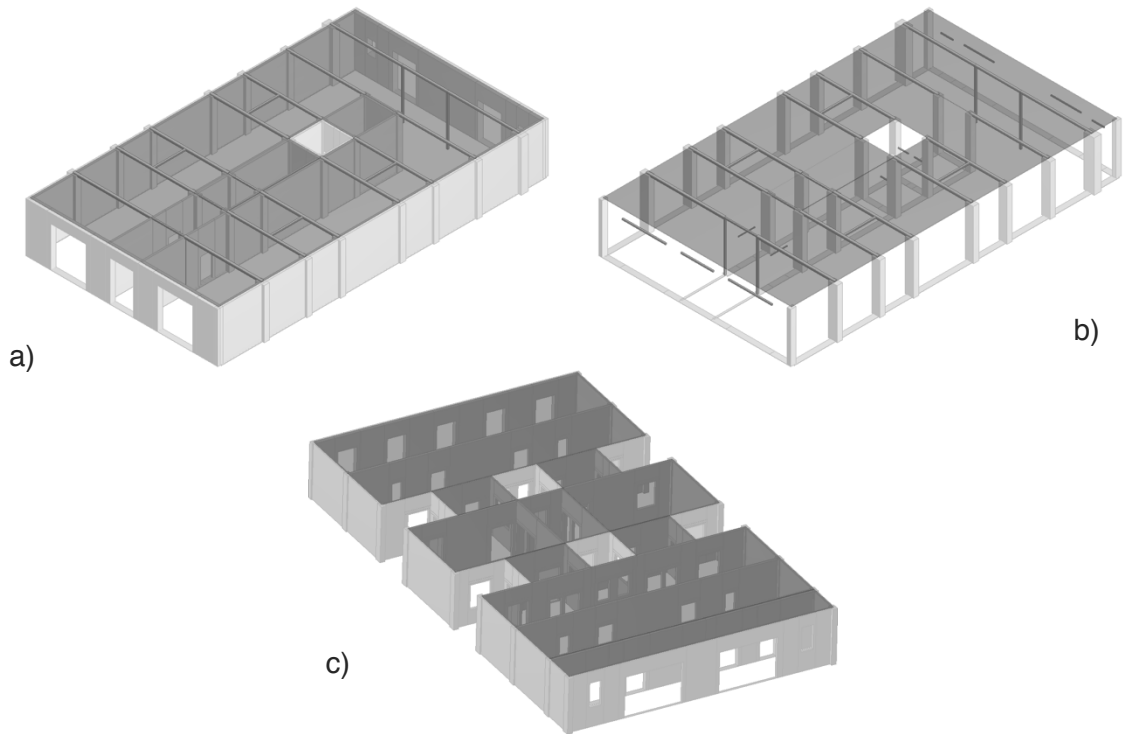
Modelo Tremuri edificio ED-01 planta baja. a) Vista isométrica fachada principal. b) Vista isométrica fachada principal sin muros. c) Vista isométrica fachada trasera
